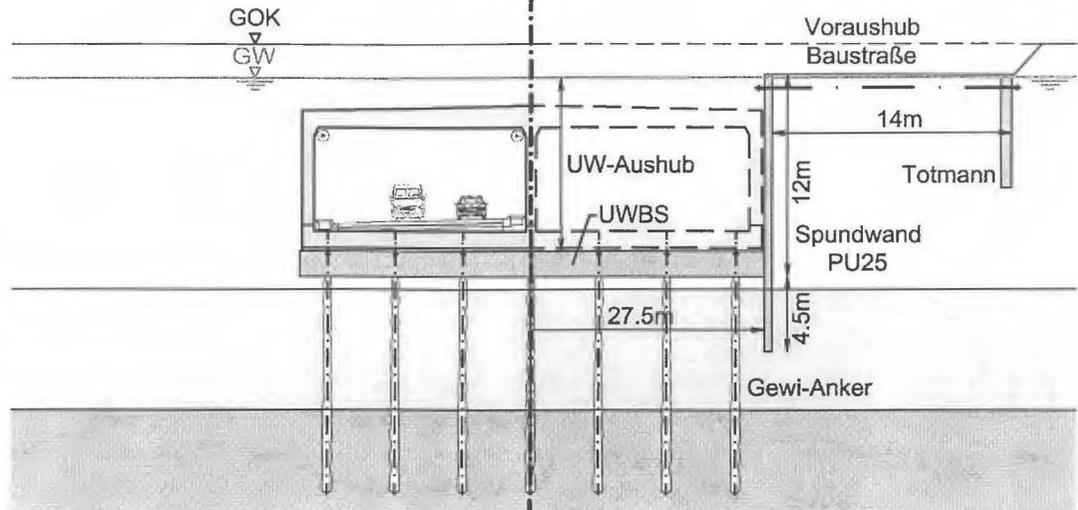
Alternativentwurf Spundwandbauweise mit Unterwasserbetonsohle
